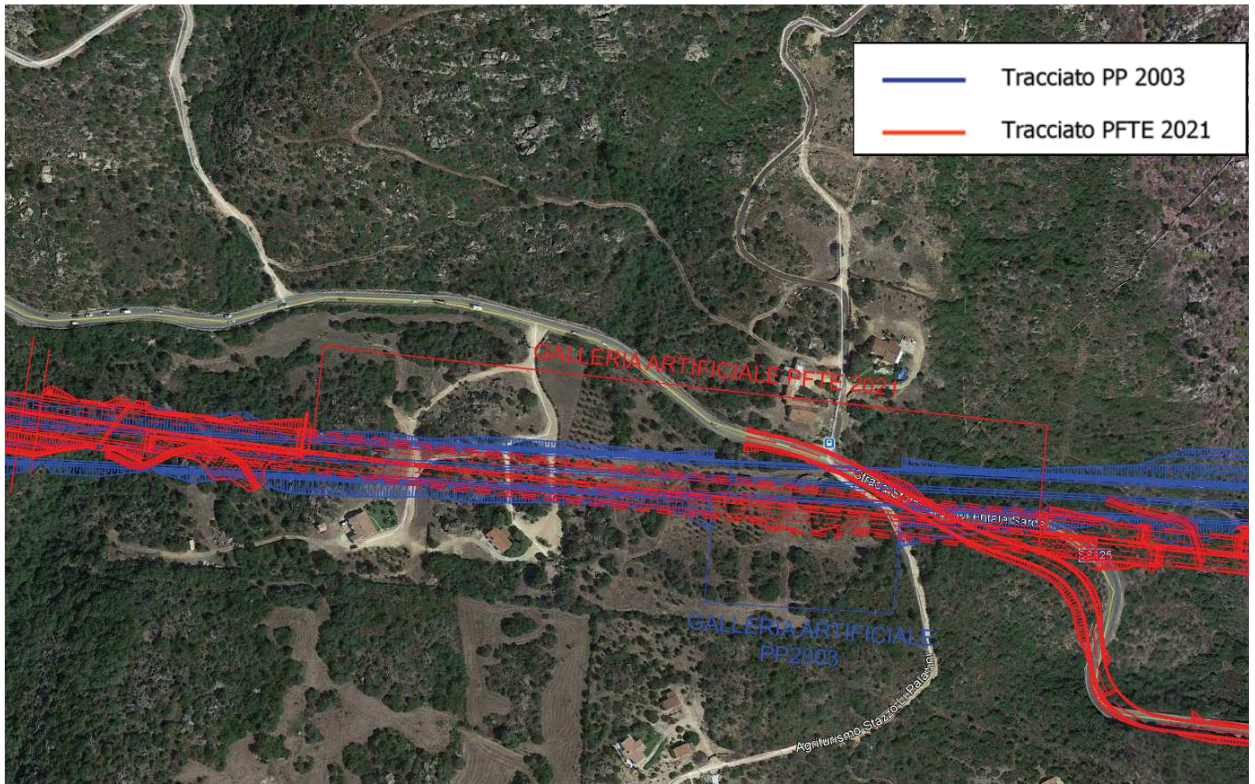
Raffronto tratto in galleria artificiale - planimetria
